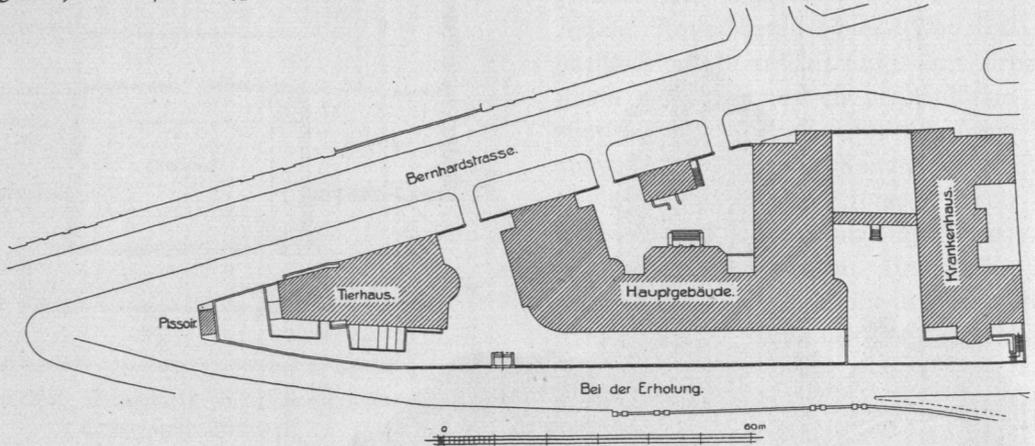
Institut für Schiffs- und Tropenkrankheiten, Lageplan.
